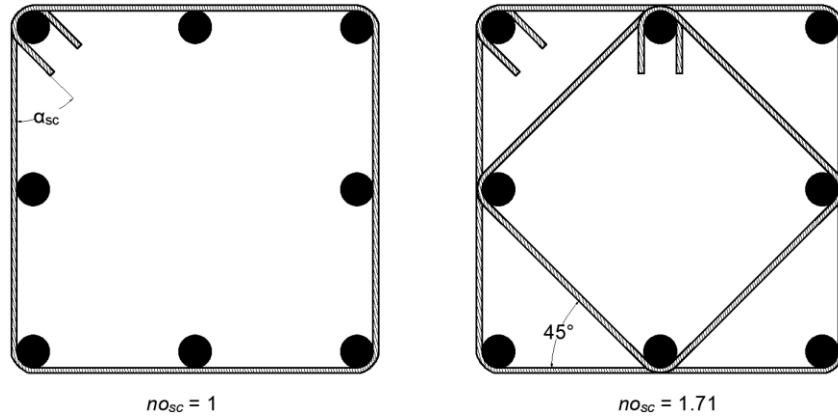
Tipos de estribos de las columnas originales
